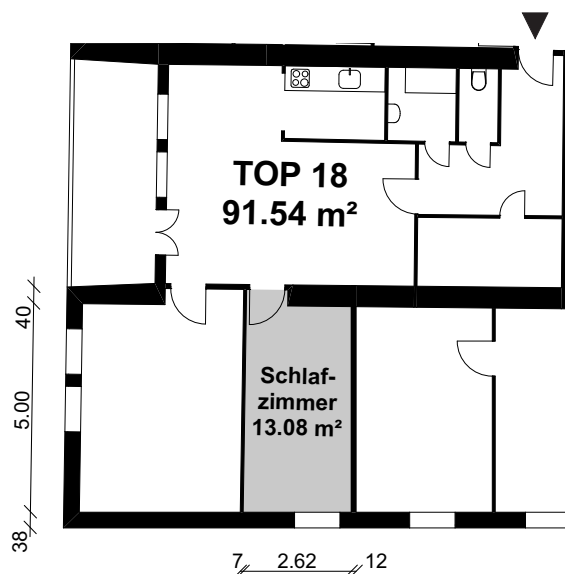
Grundriss Top 18, Stiege 1
